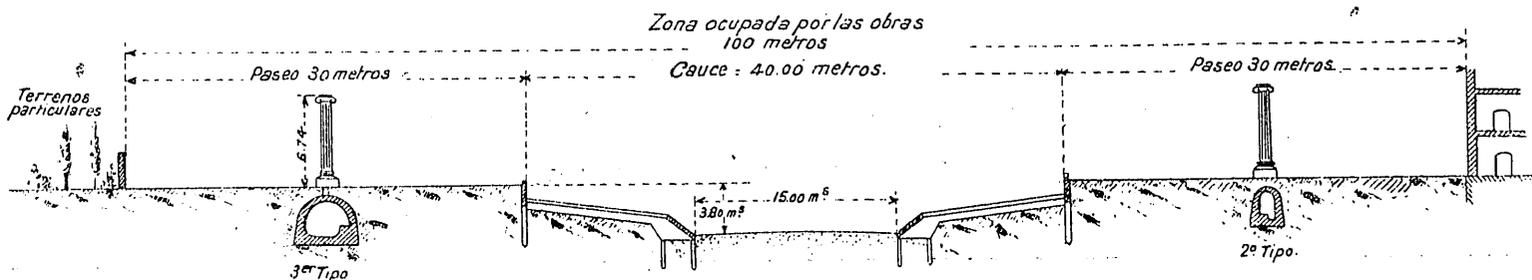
ª—Sección transversal general de las obras en ejecución.
